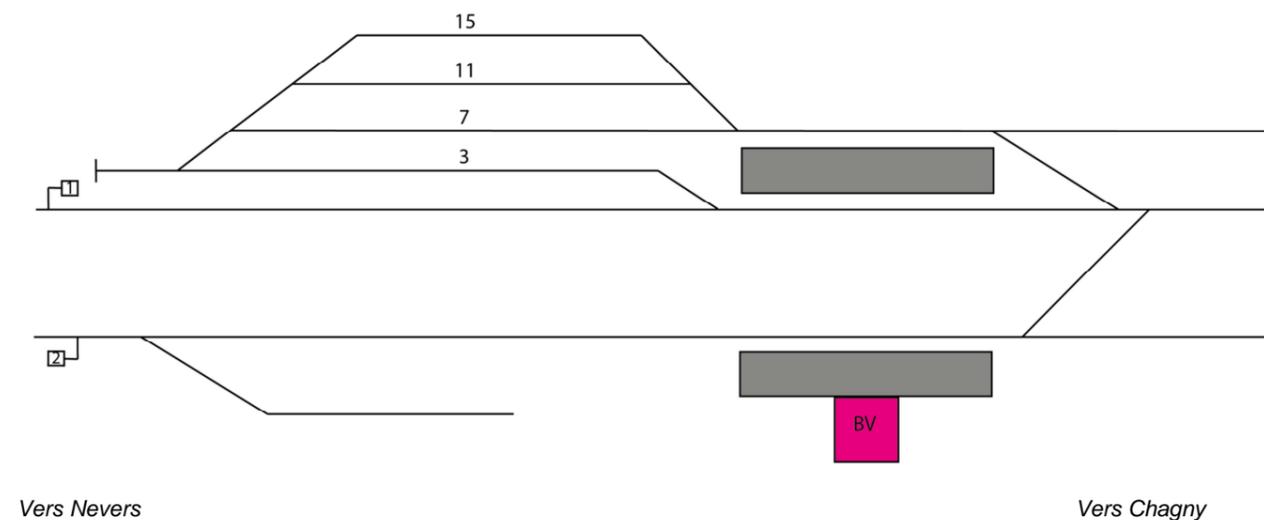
Plan de voie au niveau de la gare de Creusot-Ville
